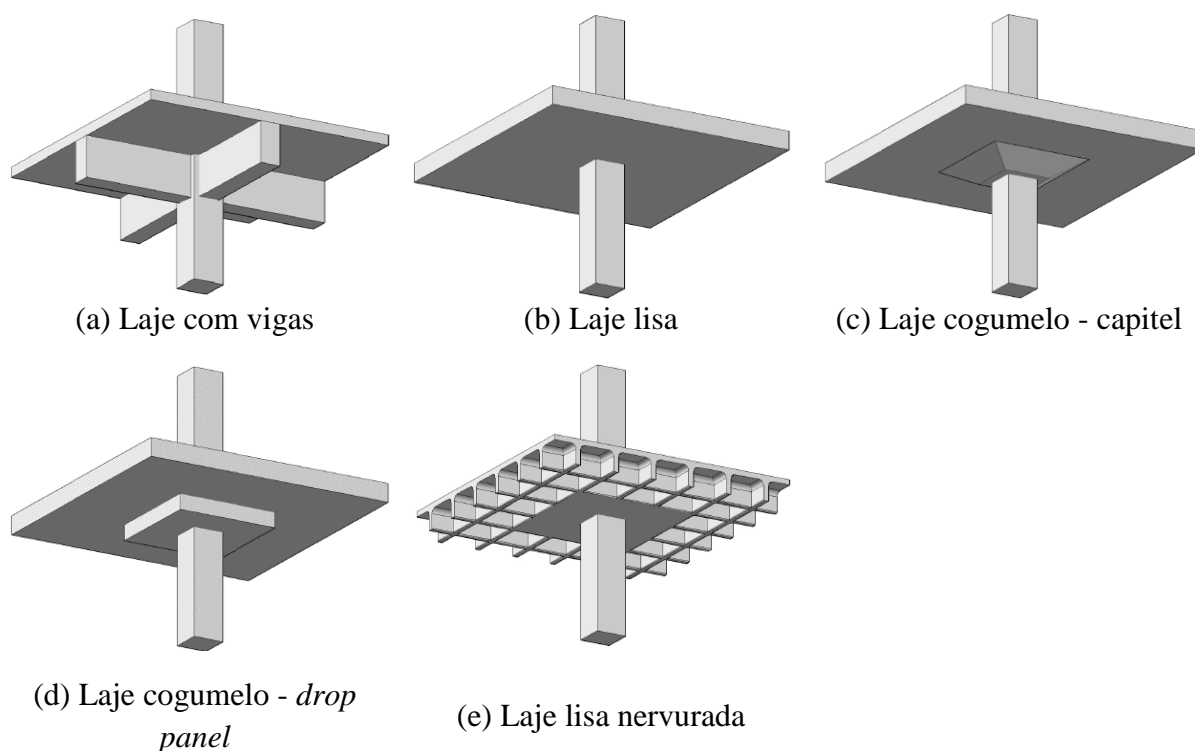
Sistemas estruturais para as lajes em concreto armado
